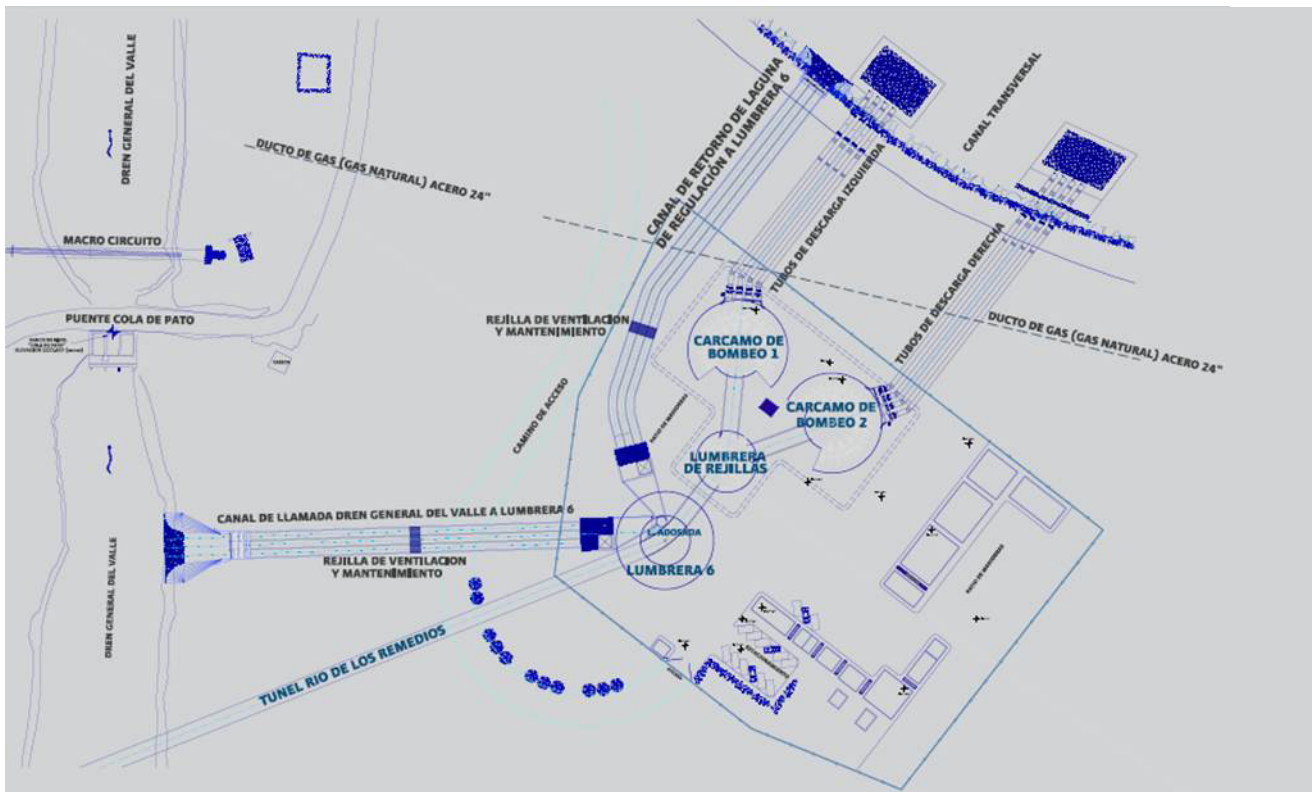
Arreglo de conjunto de la planta de bombeo Casa Colorada Profunda.
